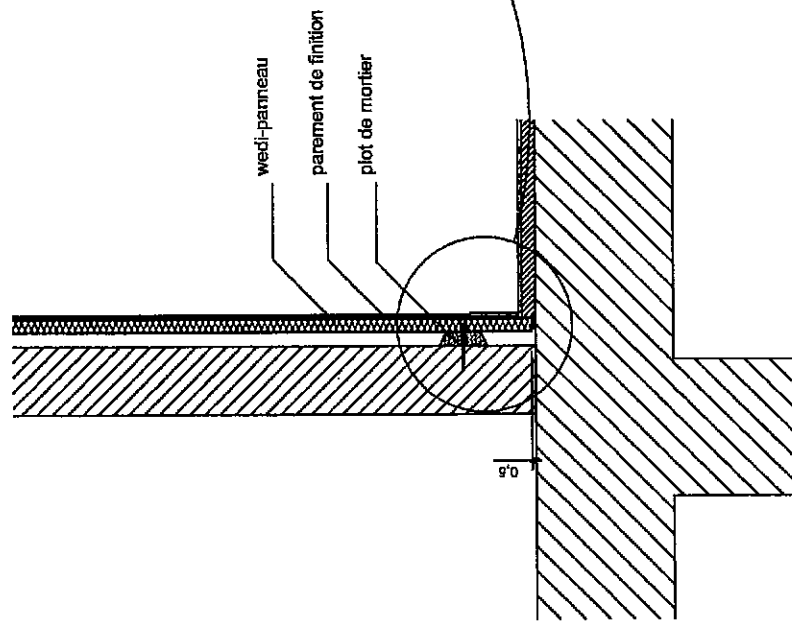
DETAIL DE LA FIXATION SUR L'OSSATURE VERTICALE
